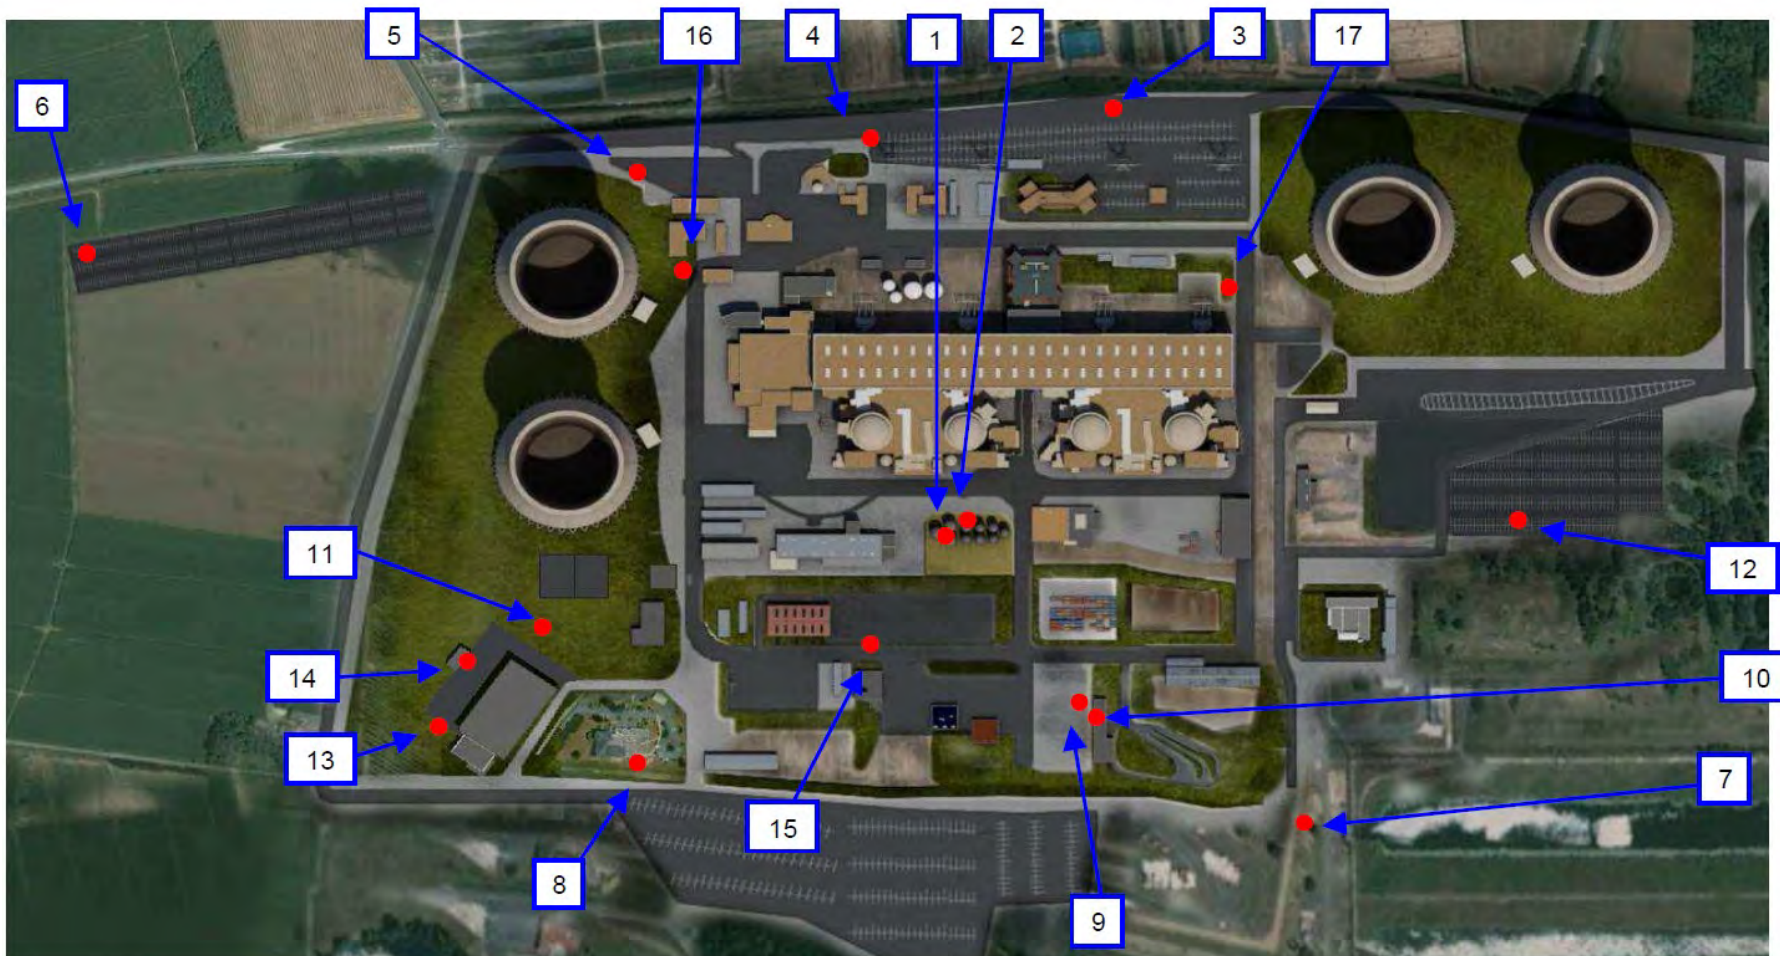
Plan de principe de l'implantation des déshuileurs sur le CNPE de Dampierre-en-Burly
